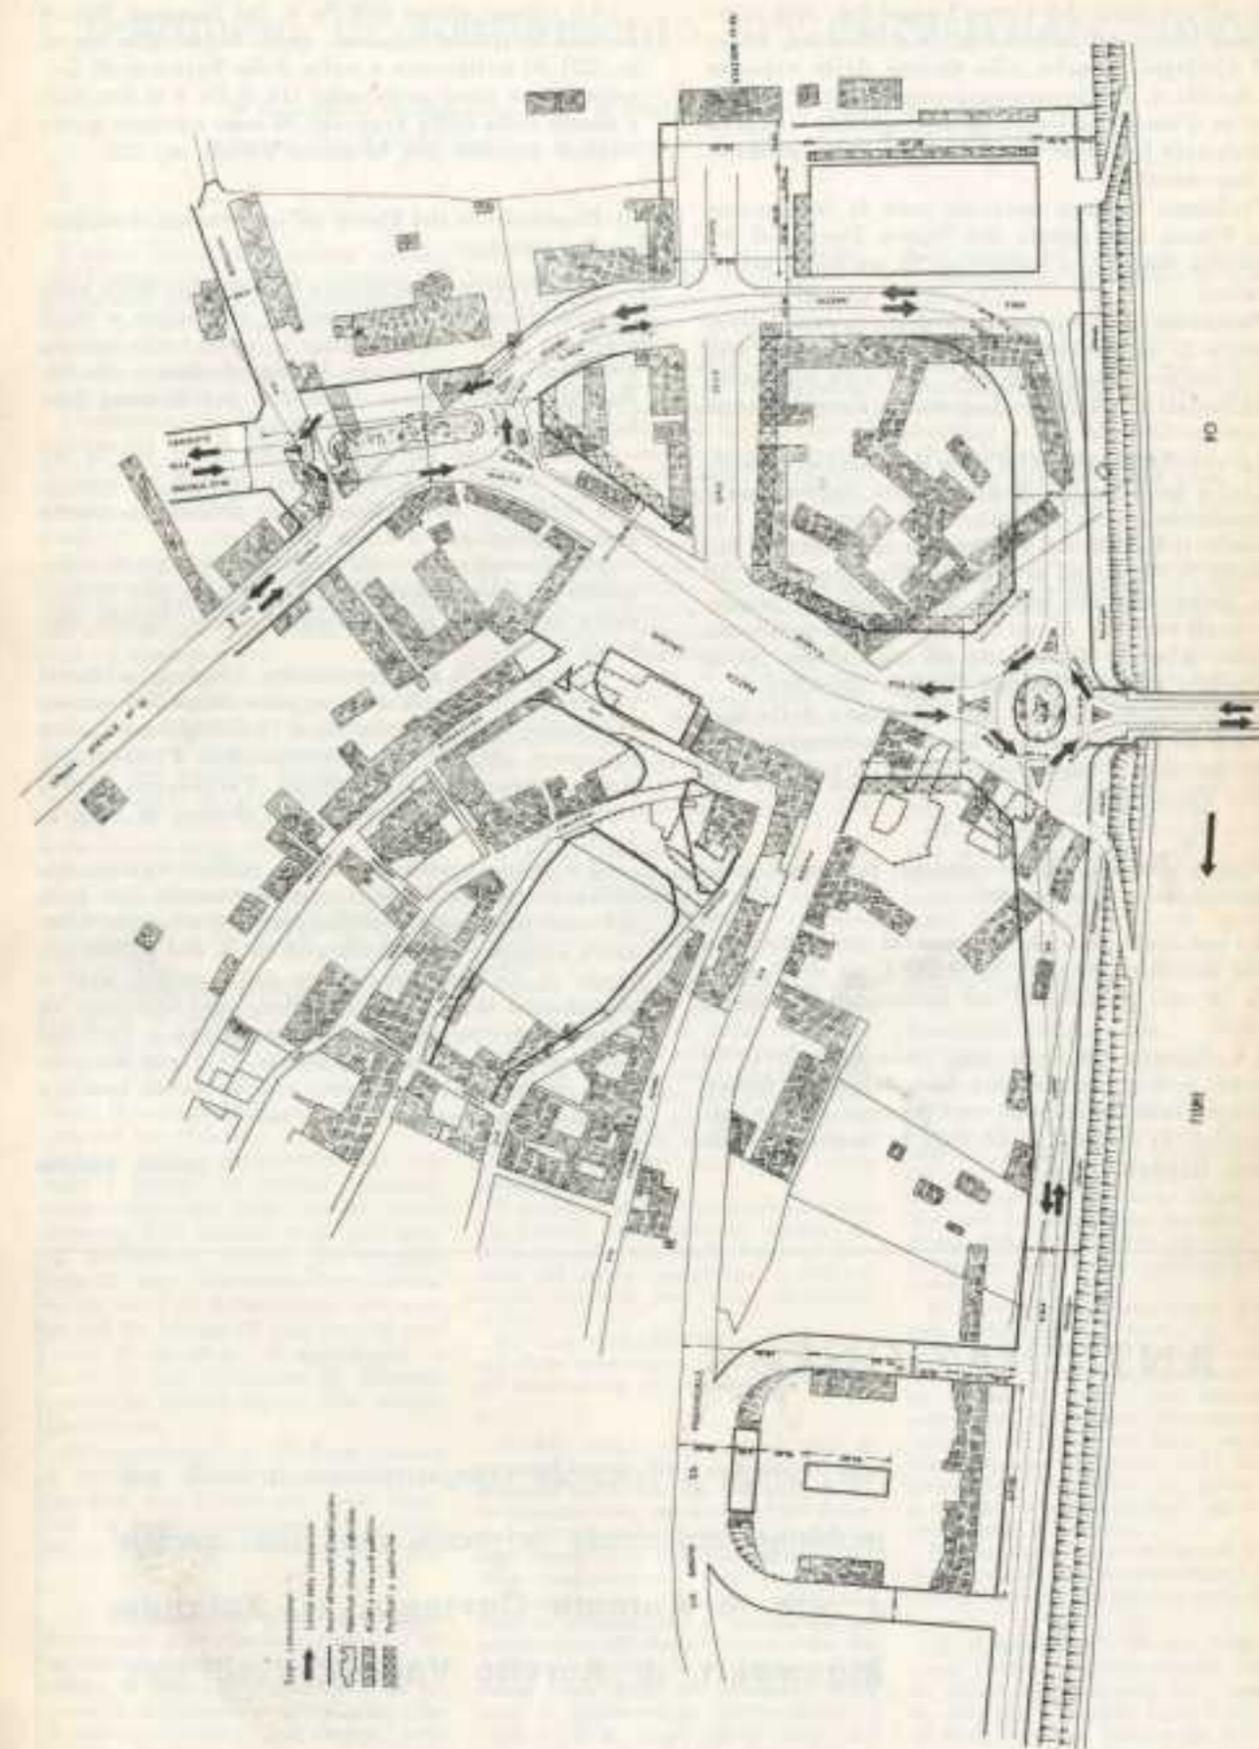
Pianificazione della Piazza Cavour ed affollamento. - Schema della regolazione circolatoria del traffico.
